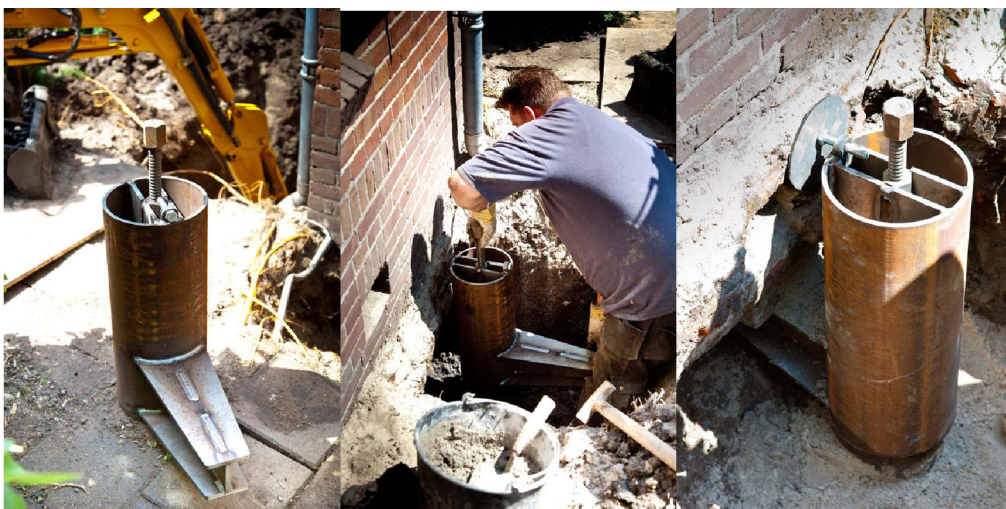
t/m 14. Aanbrengen van stalen console onder te stabiliseren muur.
